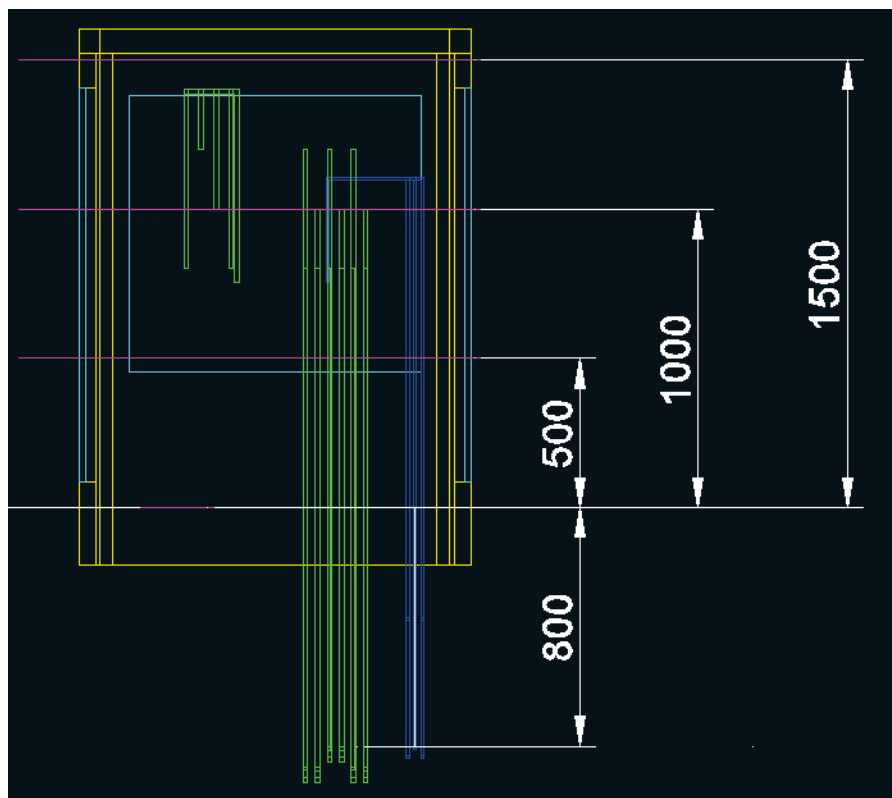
Vista en perfil de la instalación (1T [Rural]) (cotas en mm).
